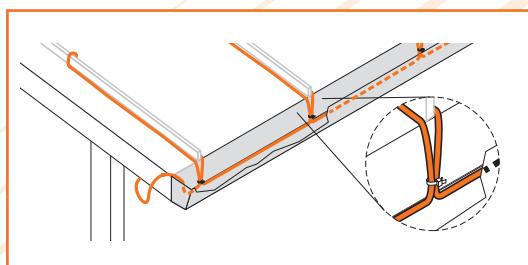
Укладка саморегулирующегося кабеля THERMON, EBECO на фальцевой кровле
